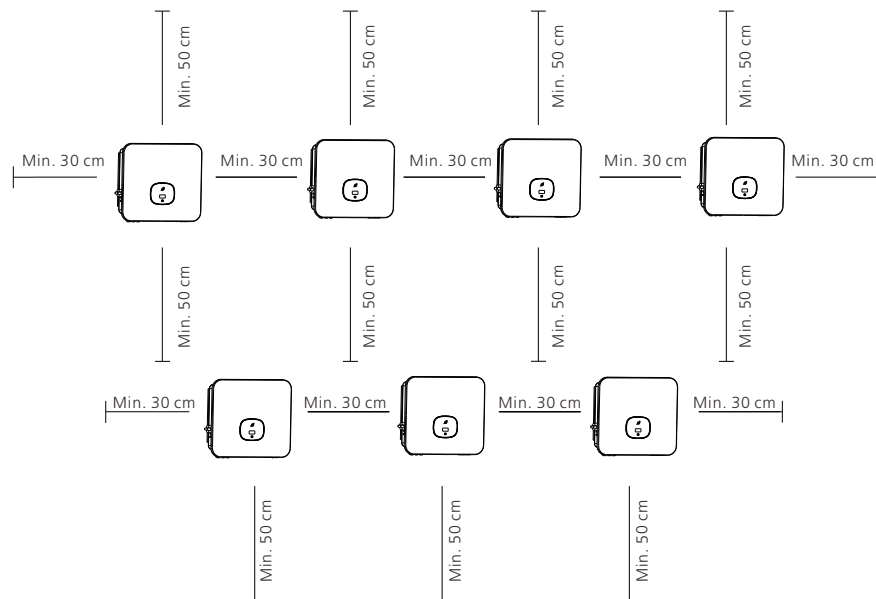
Installatieafmetingen voor meerdere omvormers
